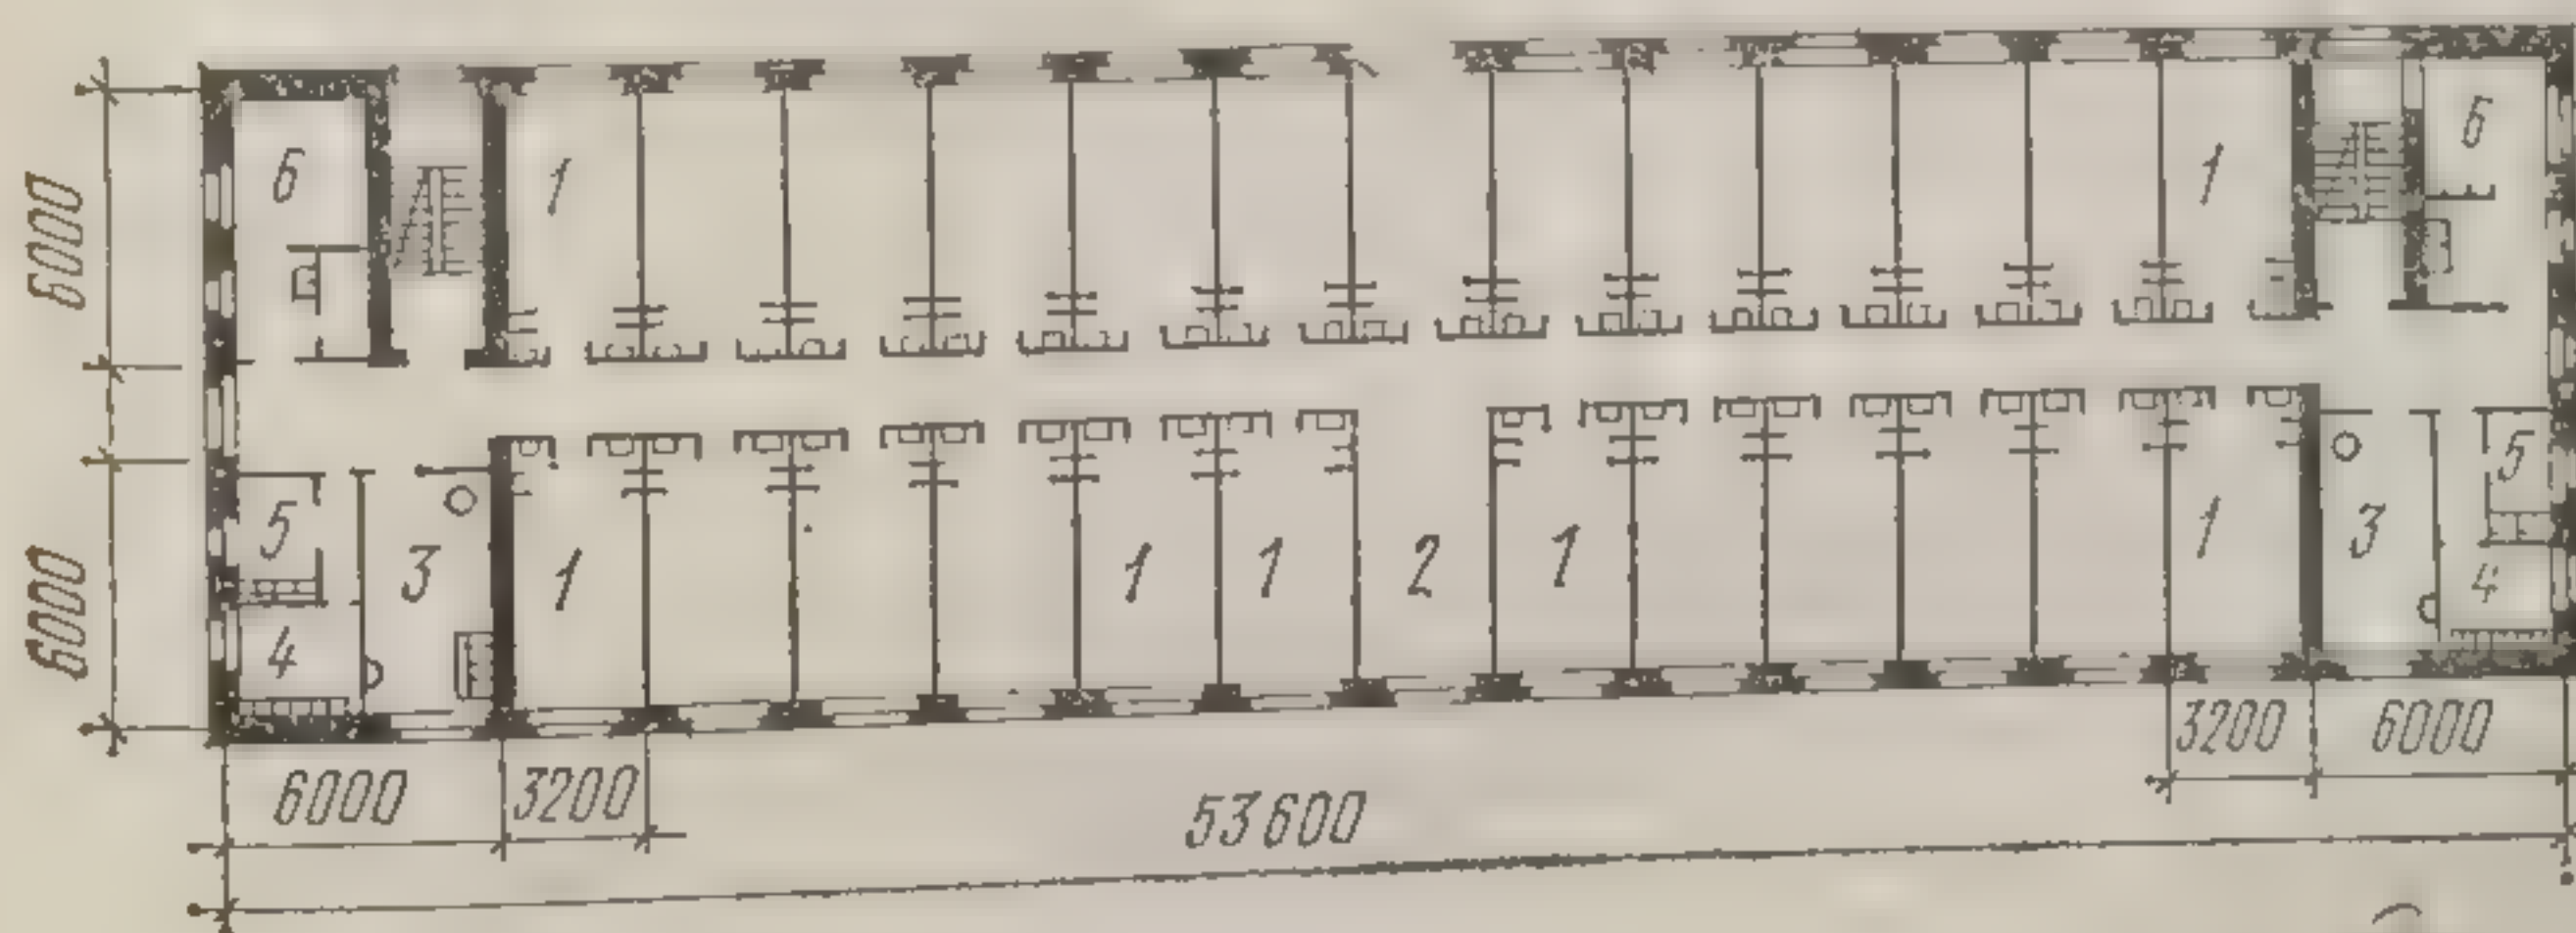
План типового этажа студенческого общежития на 400 человек:
